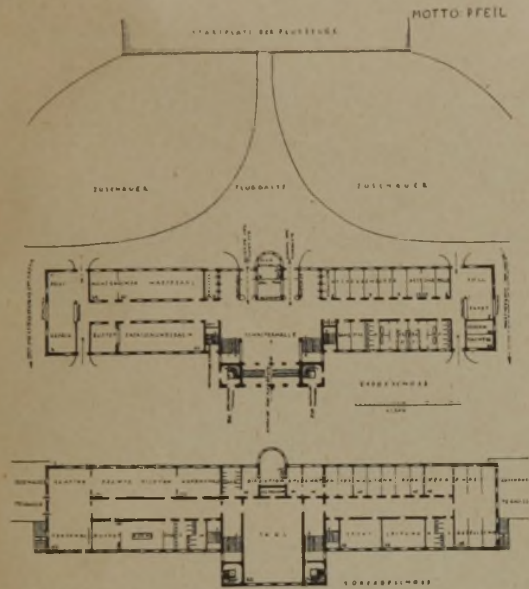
Grundrisse des Verwaltungsgebäudes. (1 : 1600.) Abb. 9. Lageplan der Bauten. (1 : 8000.)
